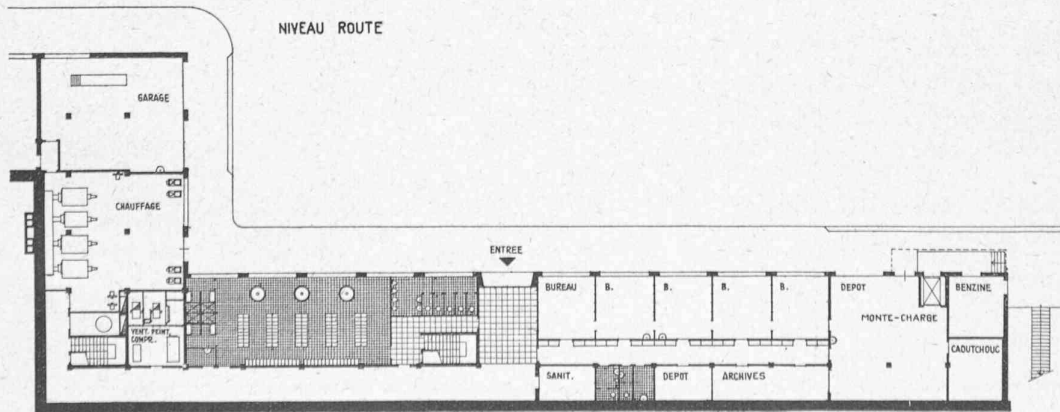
Halle de montage et locaux annexes. Echelle 1 : 600.
